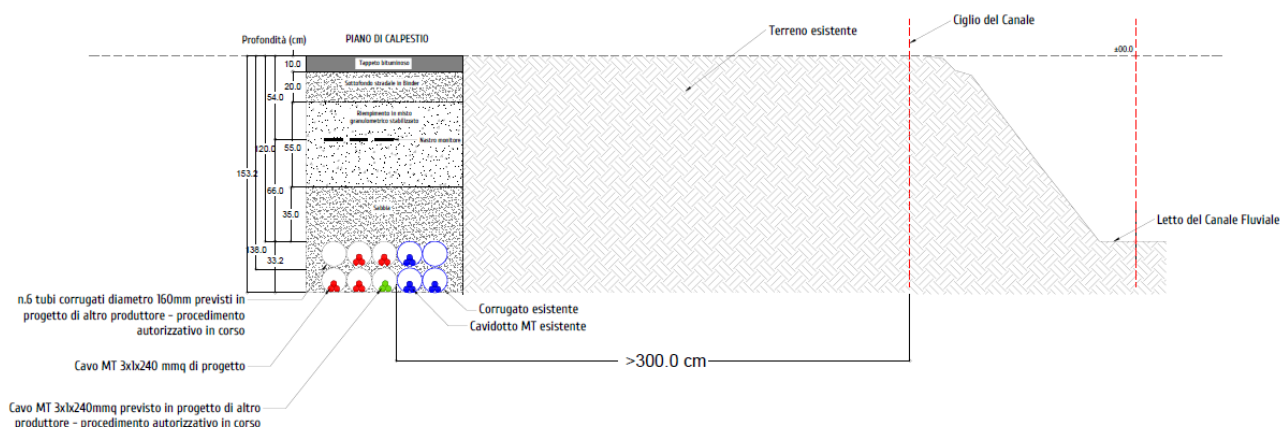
Sezione trasversale – Parallelismo con Scolo Castelvechio Superiore
